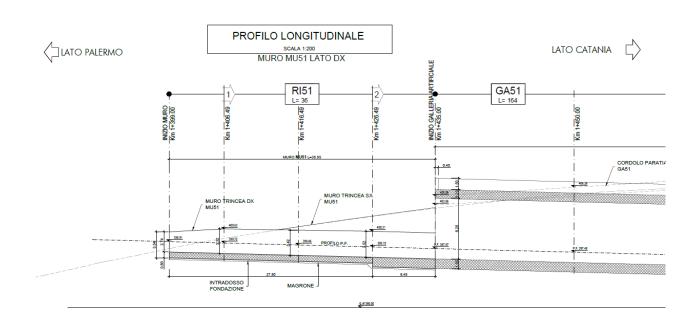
RI51: Muro a U MU51 – Prospetto lato dx.
